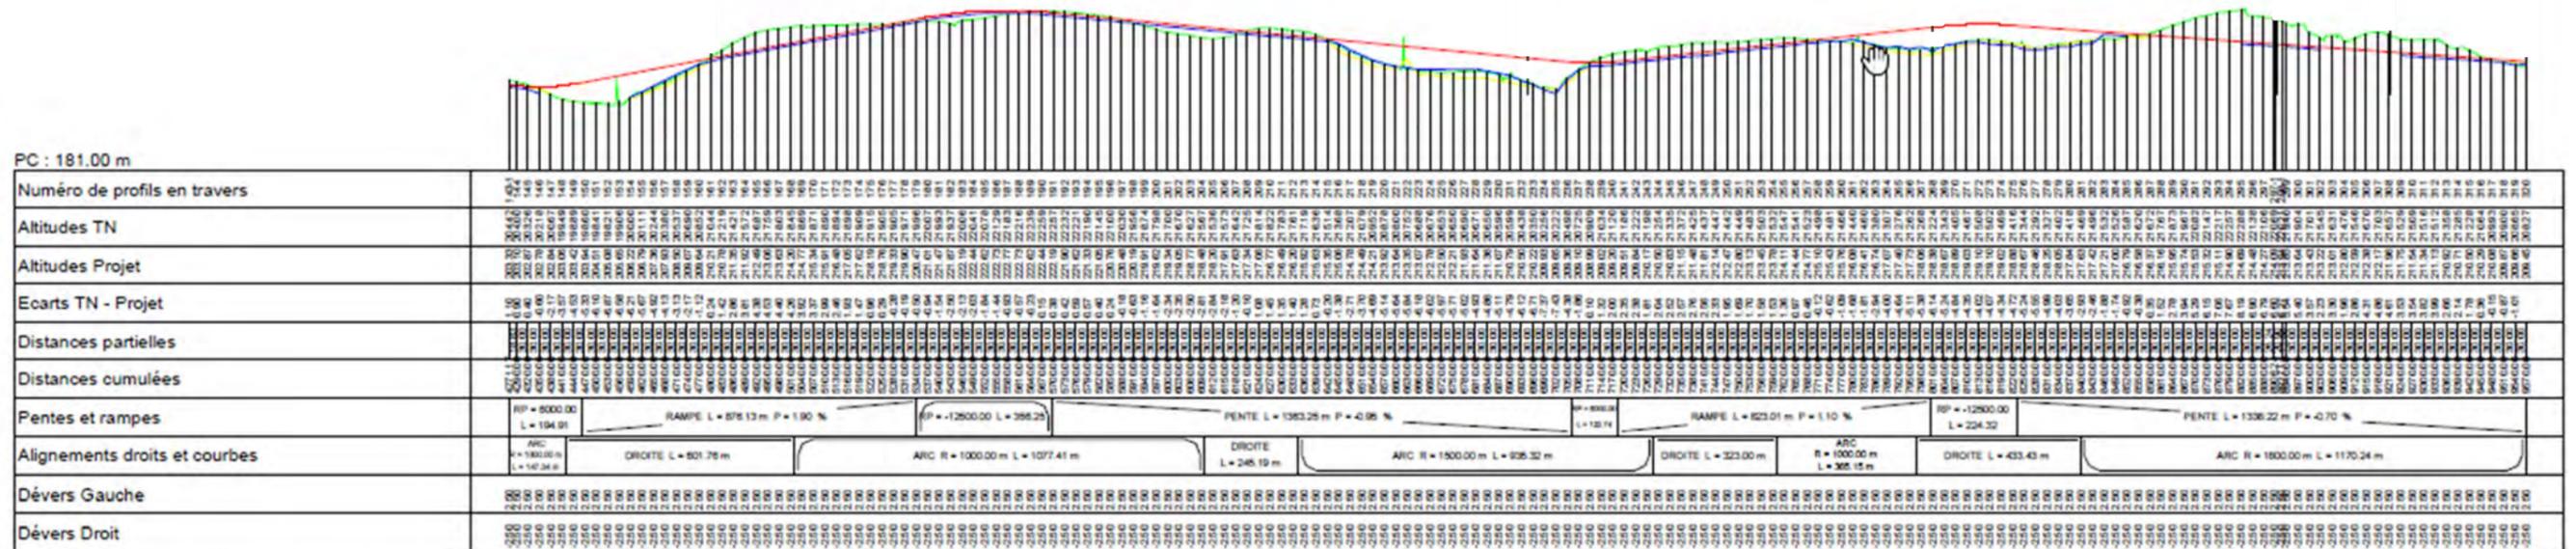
Profil en long de la section 2 (© SIROA Nantes)
